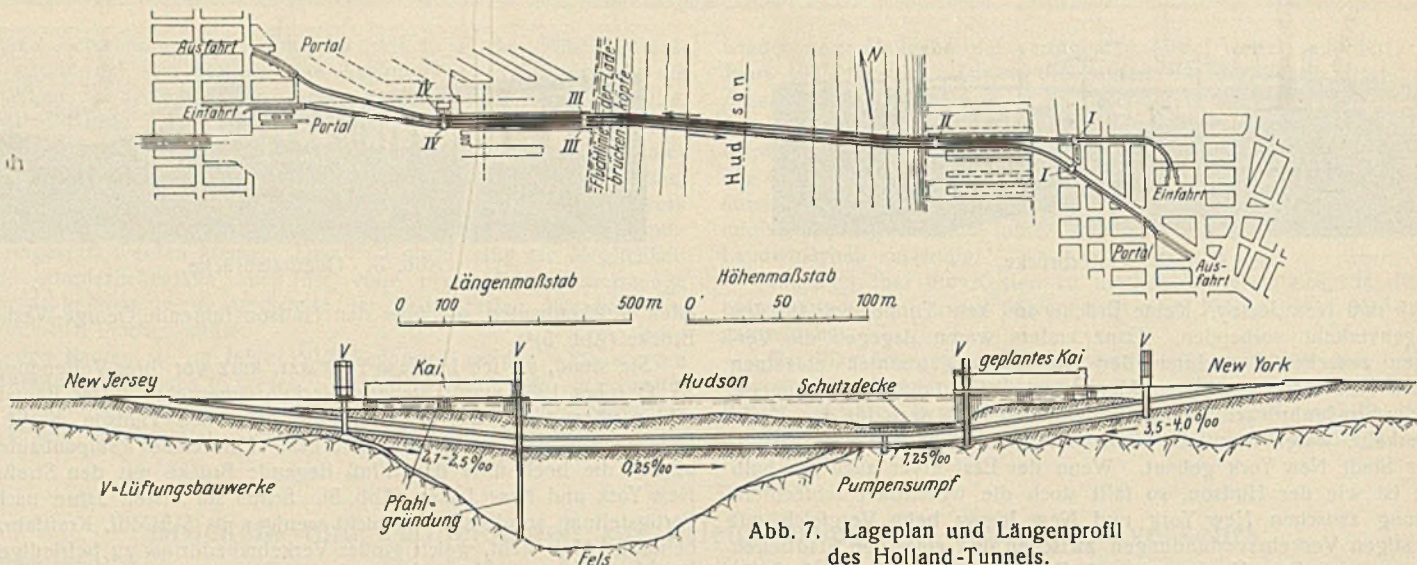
Lageplan und Längensprofil des Holland-Tunnels.
